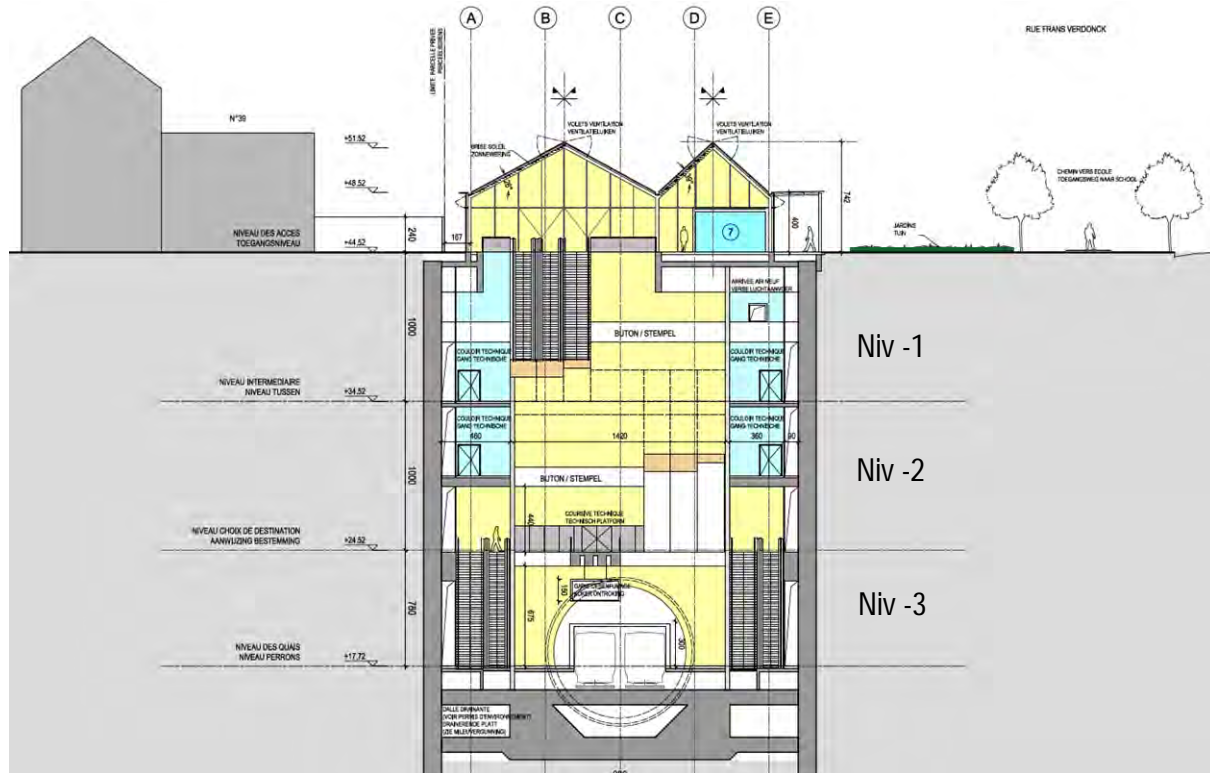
Coupe transversale de la station Tilleul (BMN, 2018)
